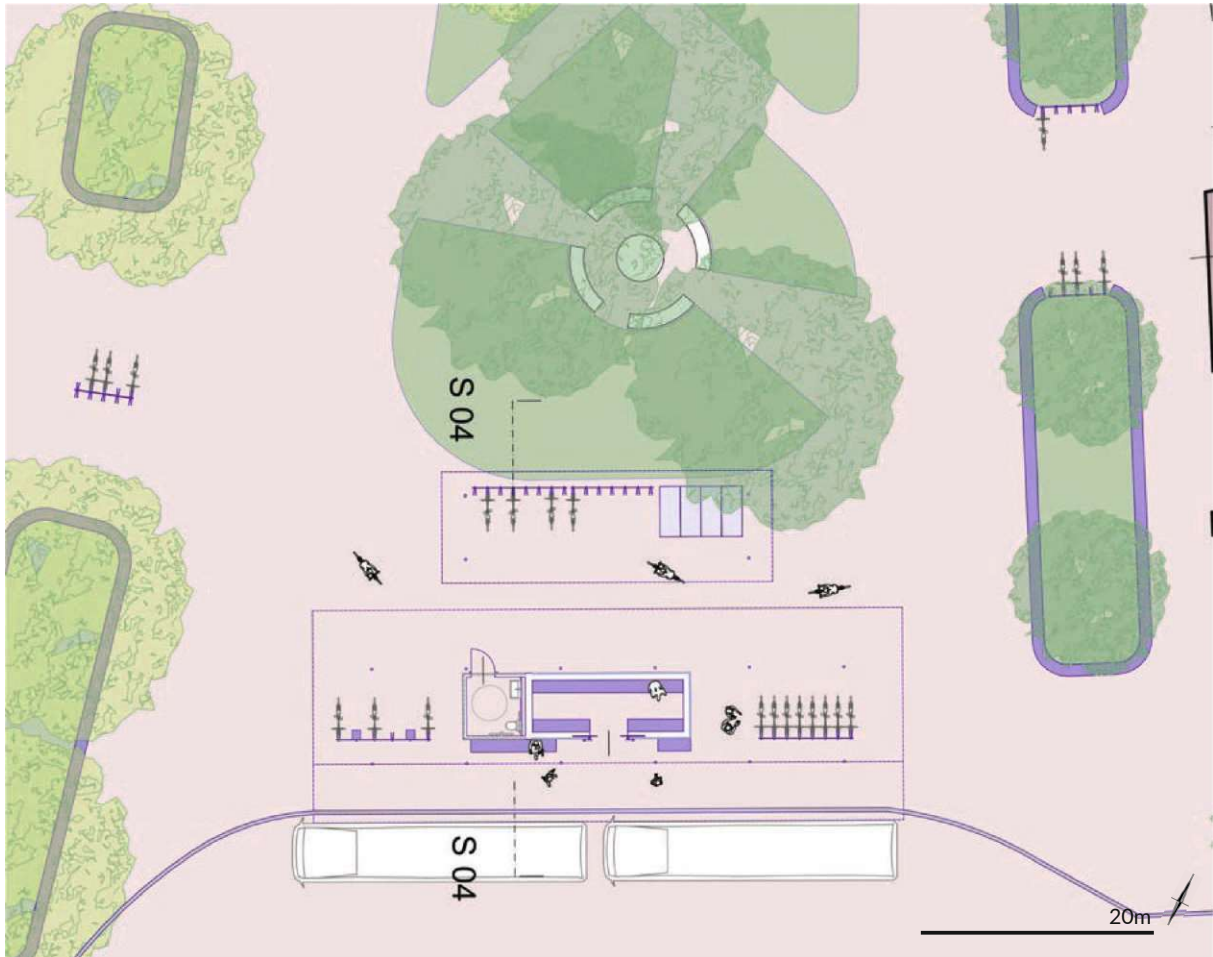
Grundrissausschnitt Bushaltestelle, eigene Darstellung
